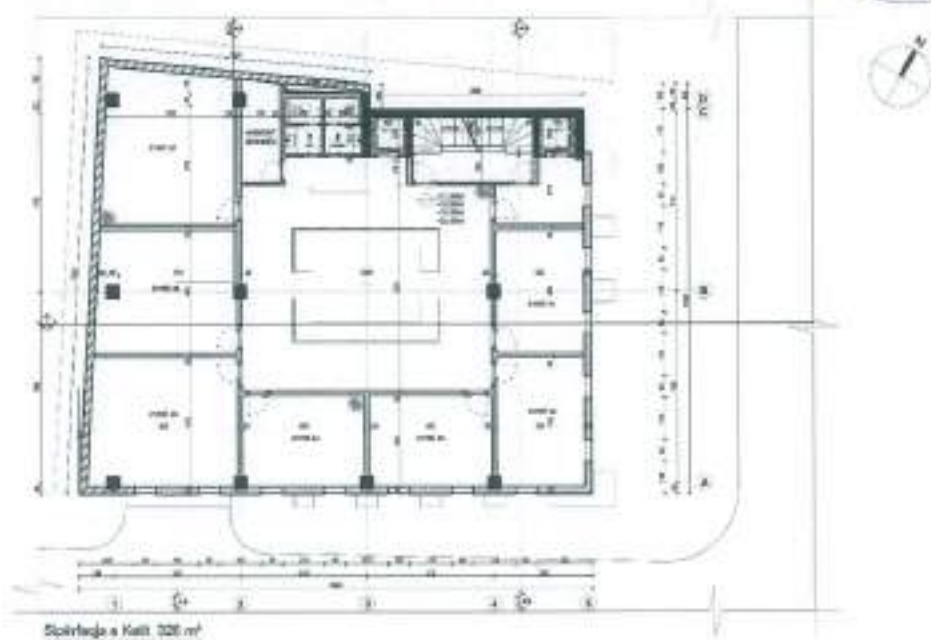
Planimetria në Kuotën + 11.55,+15.05,+18.55,+22.05
